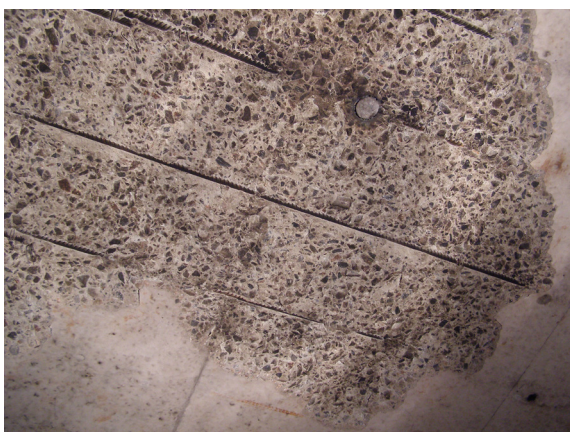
Наслідки впливу пожежі на поверхню конструкції
